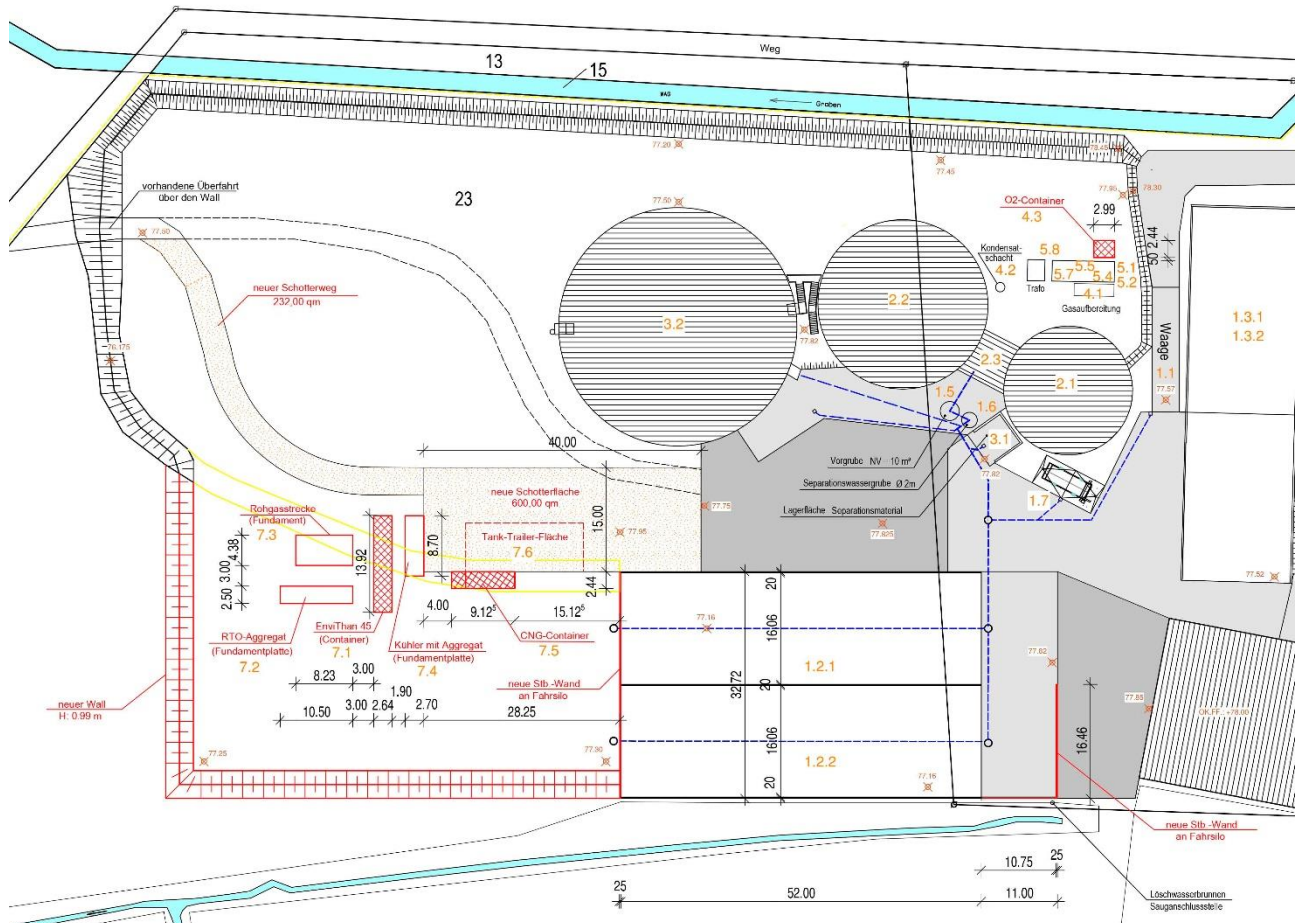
Lageplan der geplanten Gasaufbereitung (ohne Maßstab)
